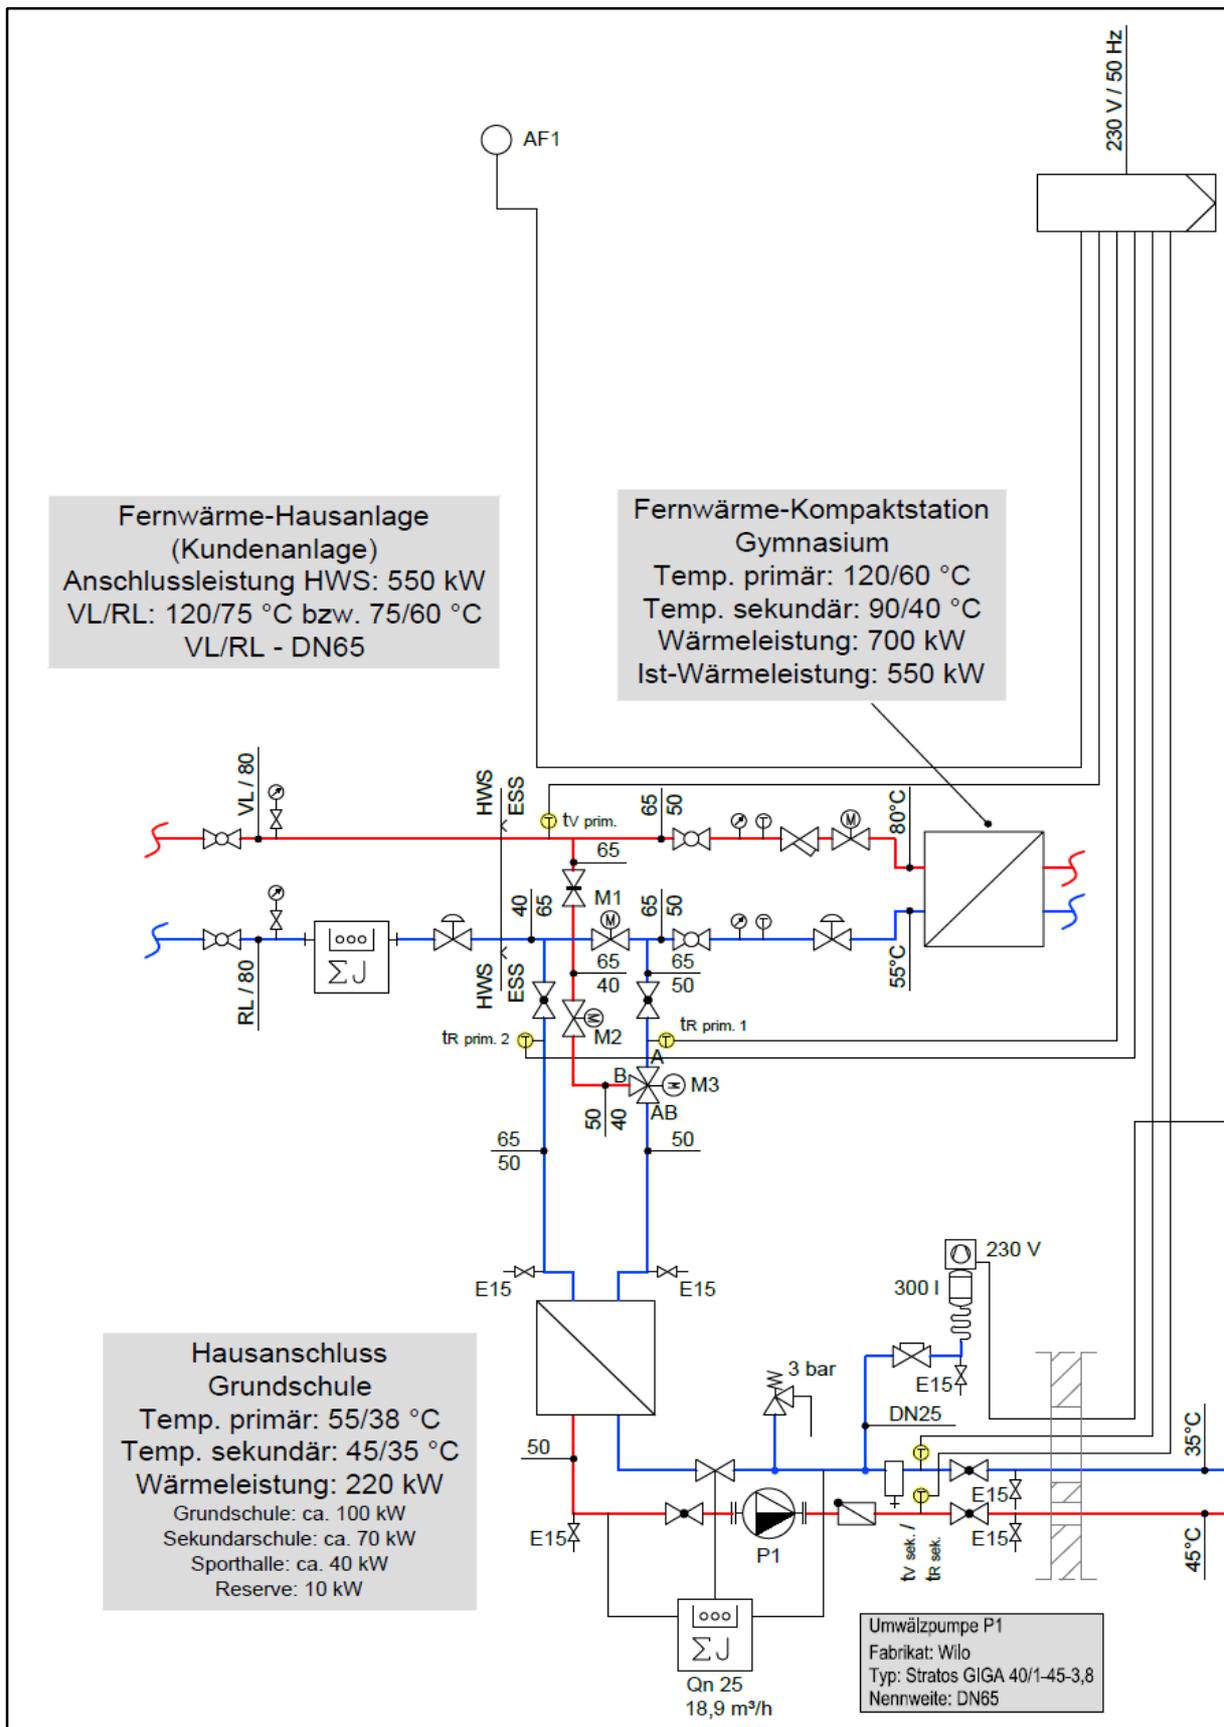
Strangschemata Heizung – Details zum Hausanschluss im Gymnasium [1]
